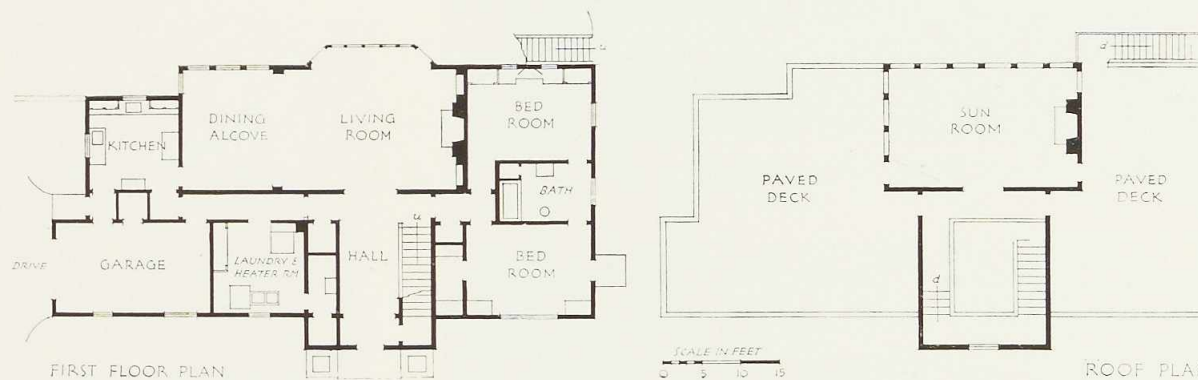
Vue en plan du rez-de-chaussée et du 1^{er} étage de la maison Rostone.
